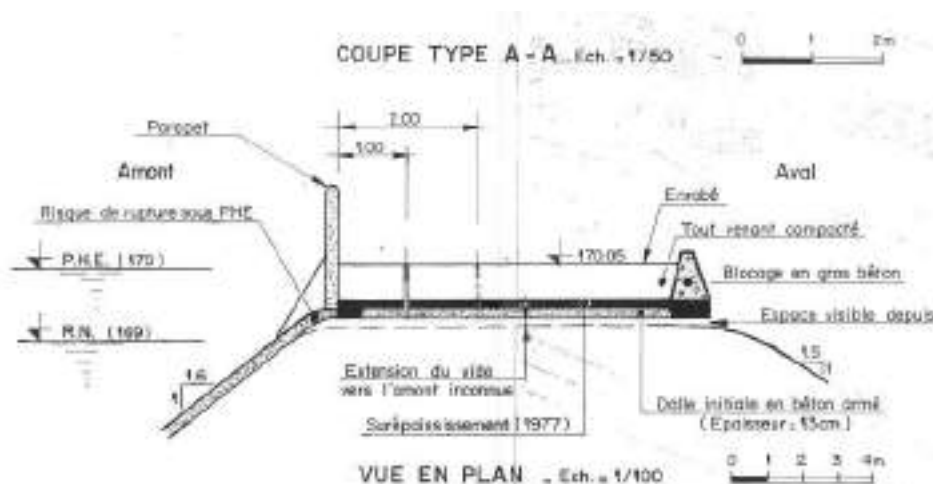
Coupe-type de la crête (extrait plan COB n°30701177 de 1994)
